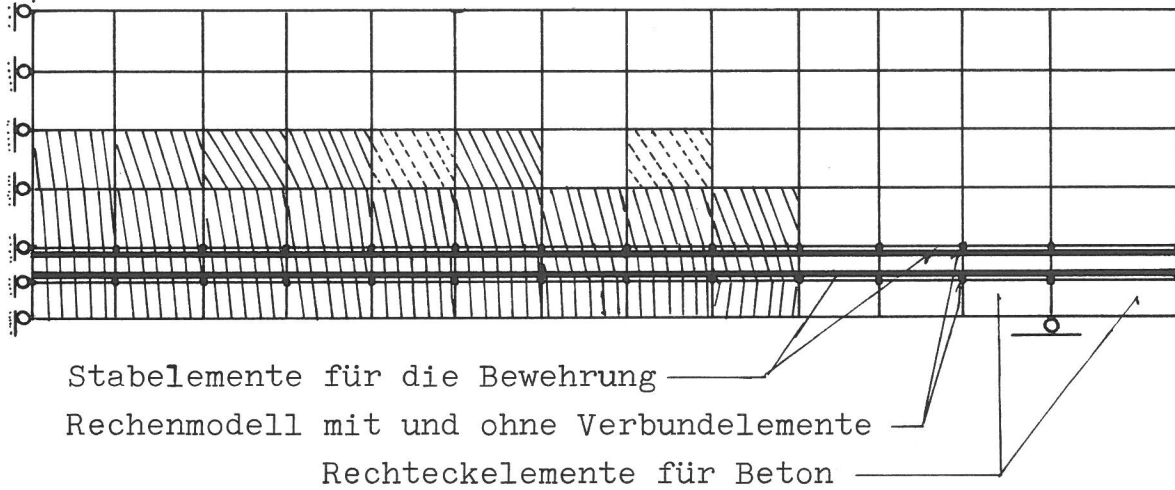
Ermittlung des Rißbildes eines Stahlbetonbalkens durch Franklin [22]
